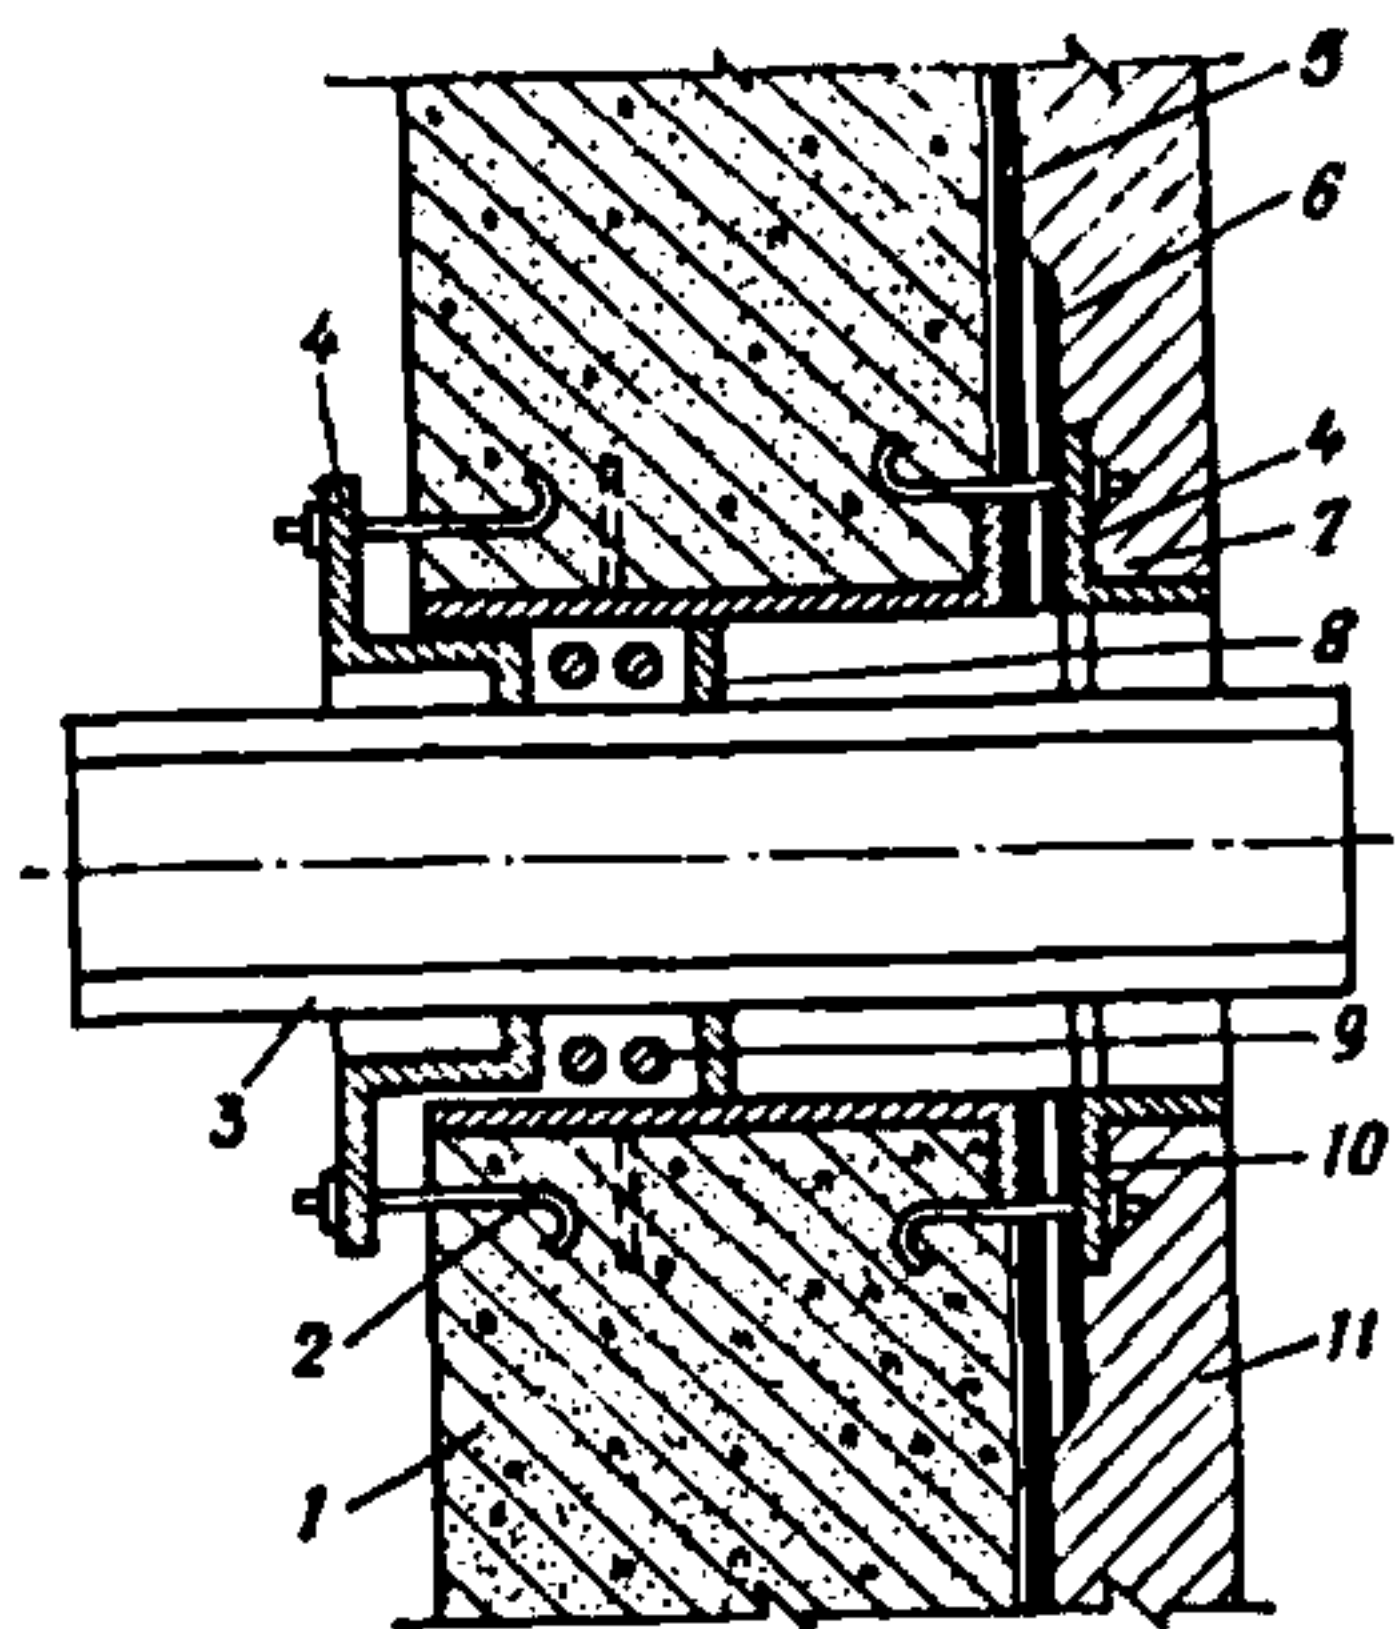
Гидроизоляция мест пропуска трубопроводов
